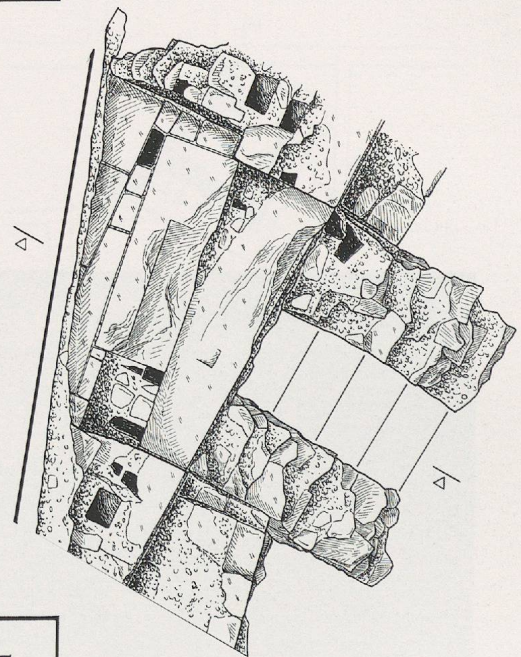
Plan de l'escalier d'accès à l'ancienne cave (éch. 1:50).
